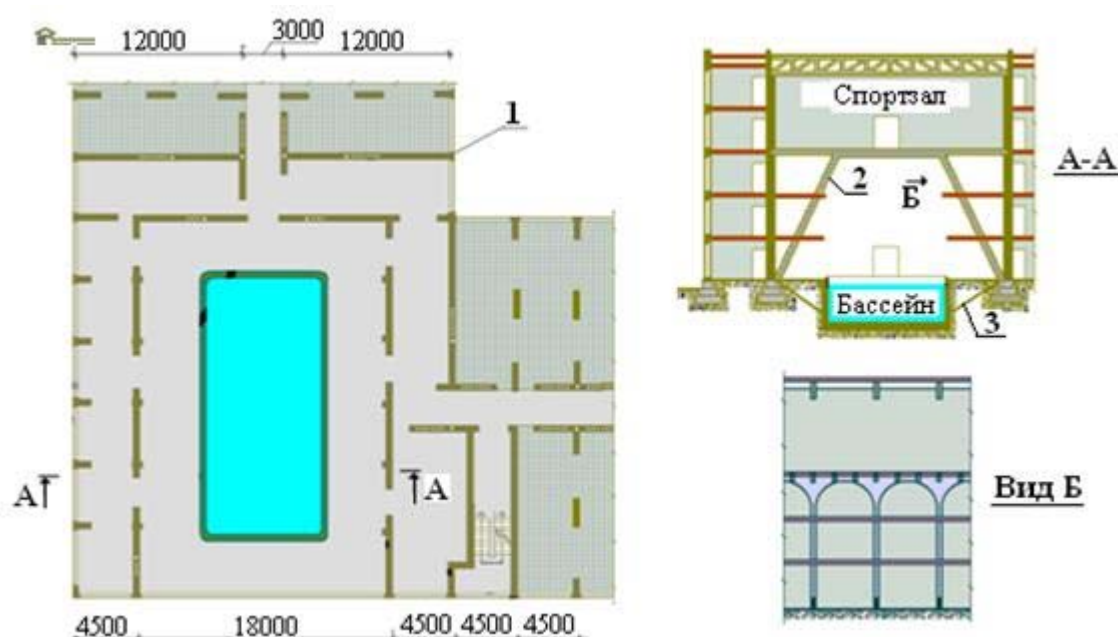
План и сечения Града построенного из каменных блоков, кирпича. 1 – стены, 2 – колонны, 3 – тросы для стягивания наклоненных колонн.
